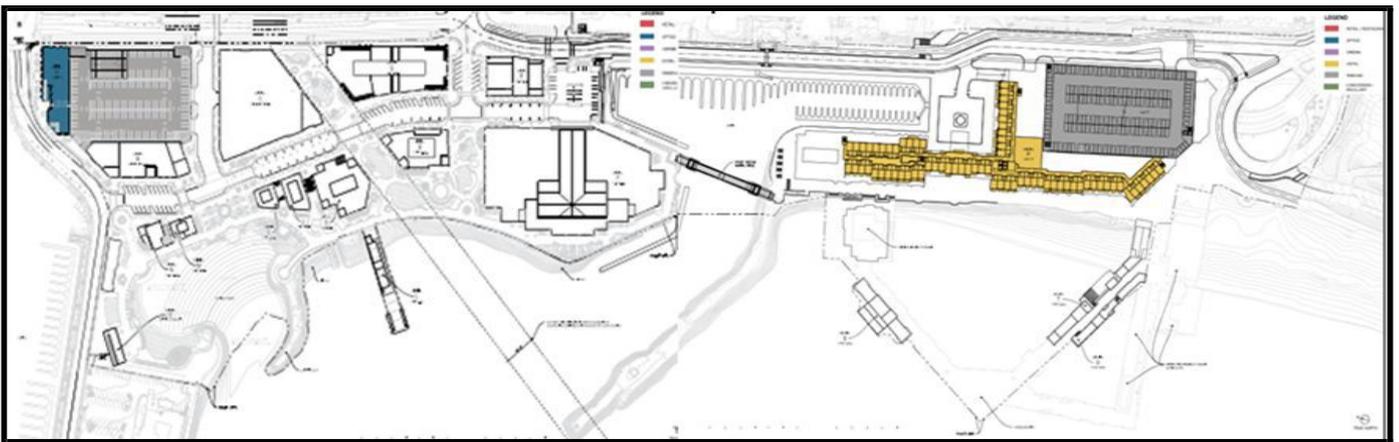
Plan niveau 03. Src: <http://www.thewaterfrontredondo.com/project-view/>.
